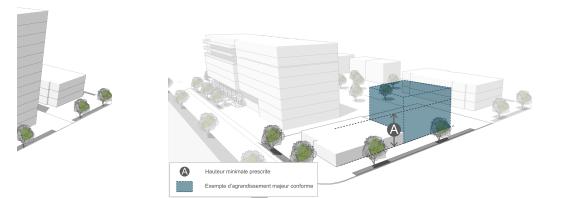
Agrandissement majeur d'une construction dérogatoire à la hauteur minimale
